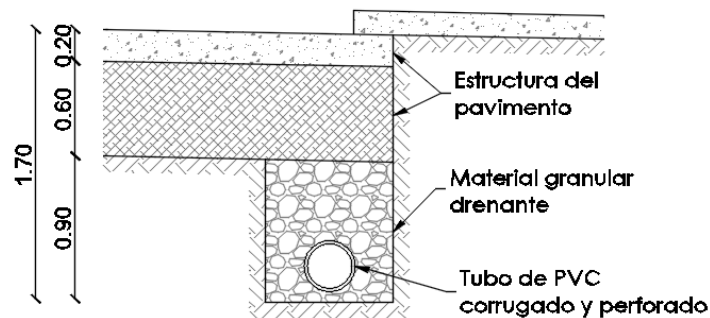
Subdren longitudinal construido en el tramo 1.
